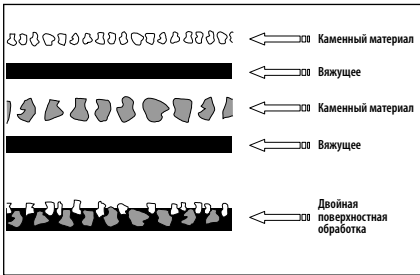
Двойная поверхностная обработка (double Chip Seal)
